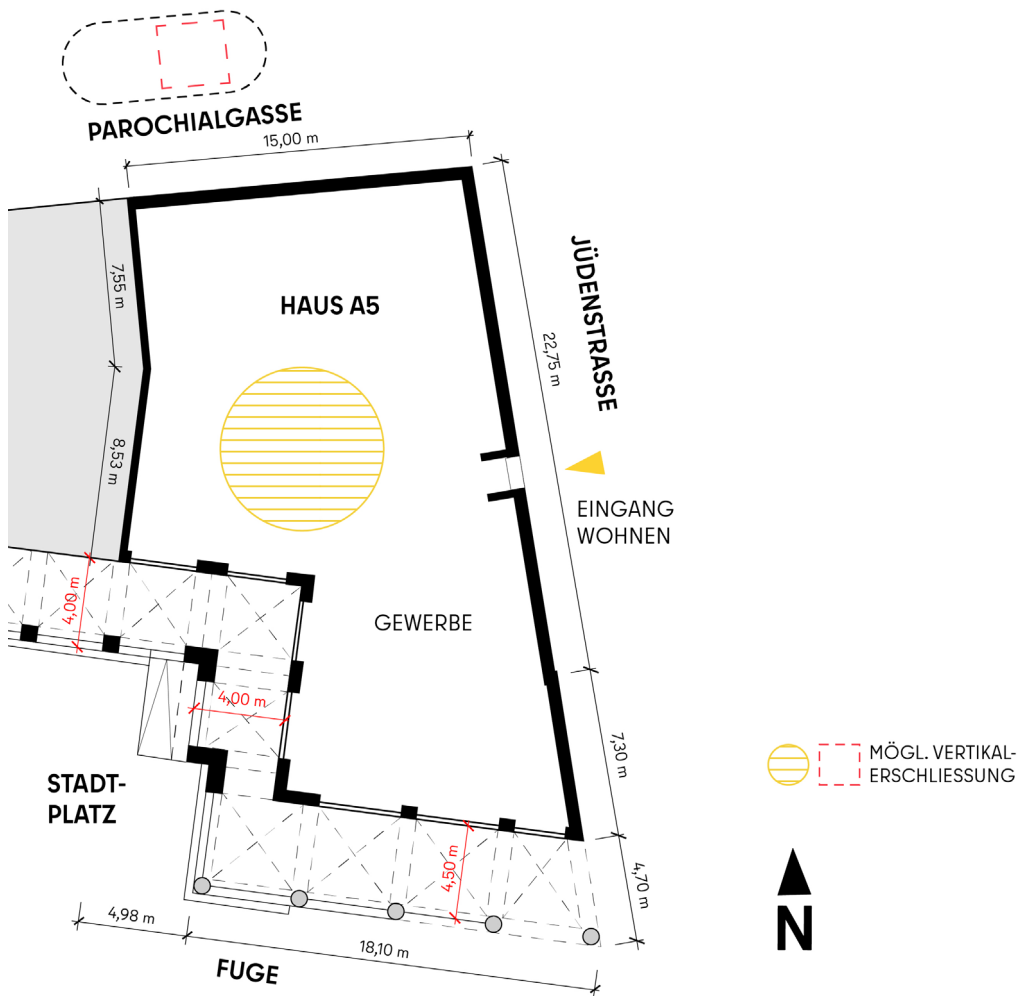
Schematischer Grundriss Erdgeschoss (mit noch zu prüfendem Pavillon im Bereich der Parochialgasse)
